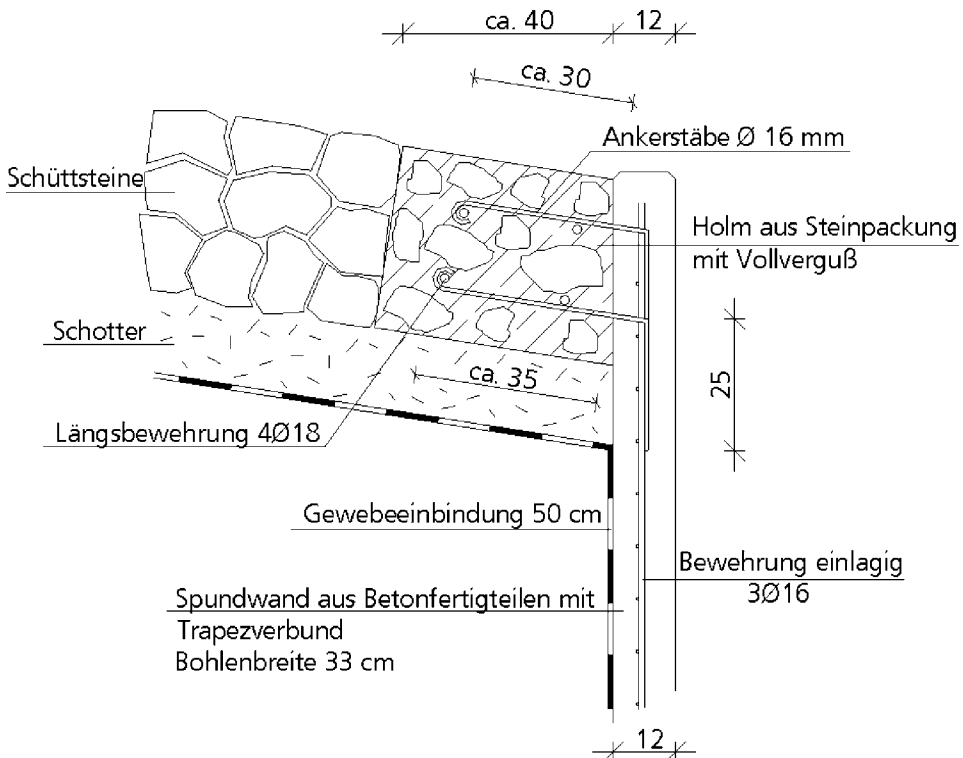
Vertikale Fußausbildung aus Stahlbetonbohlen und anbetoniertem Ortbetonholm
